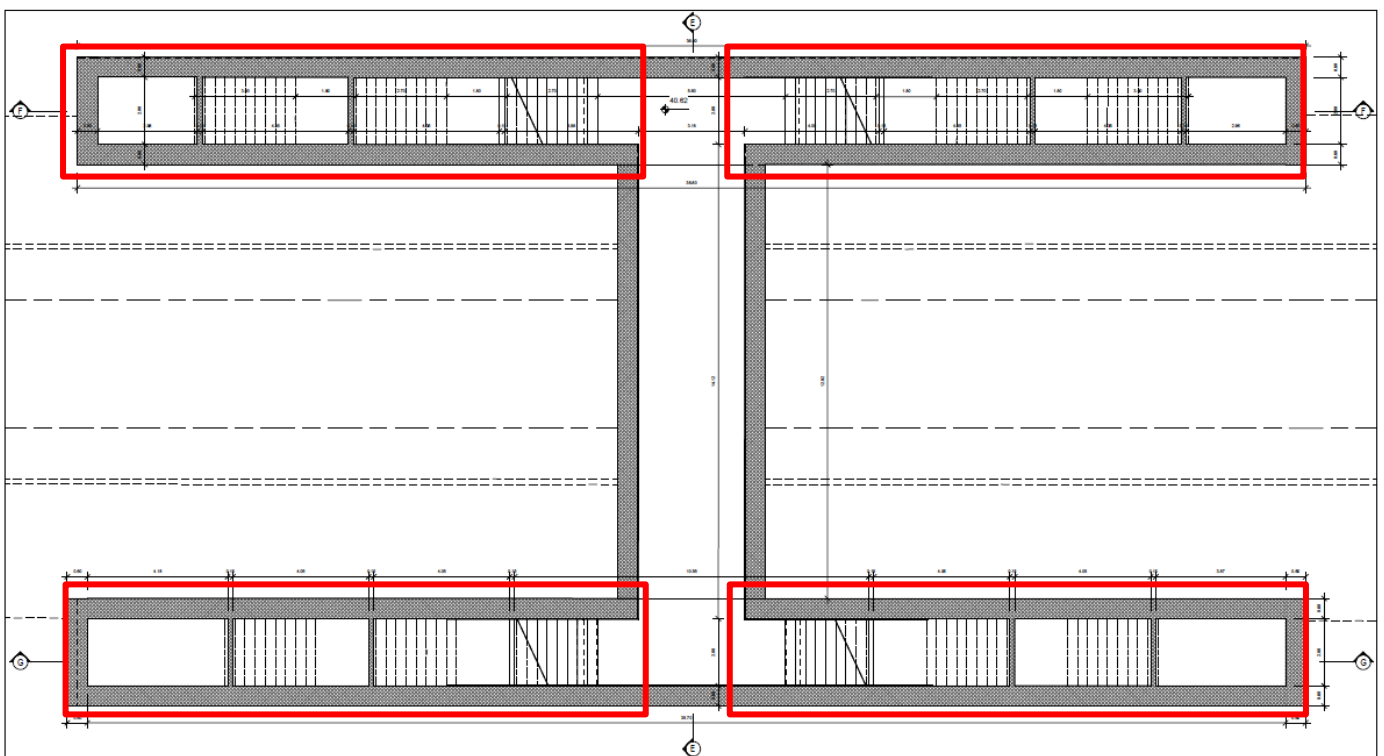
Planimetria dell'opera con individuazione dei vani scala
